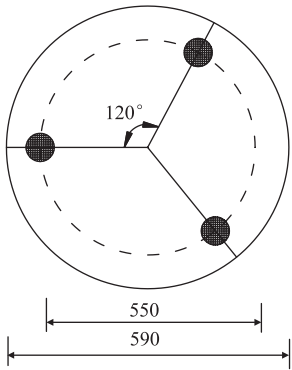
桩端土压力盒平面布置以及孔口限位装置平面图(mm)
